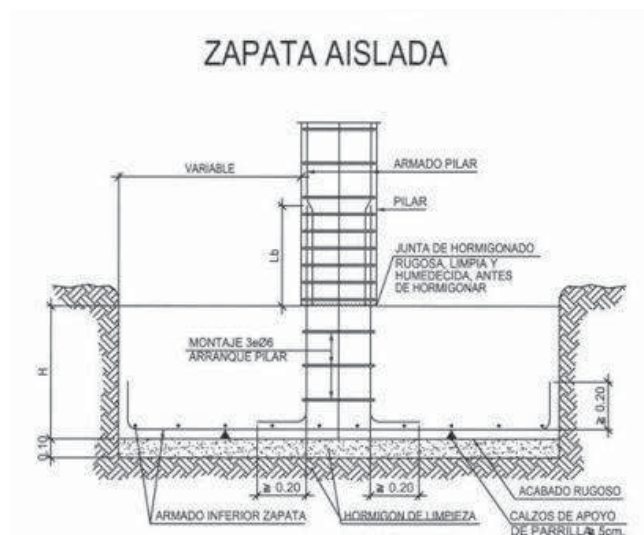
Detalle constructivo de una zapata aislada¹⁰³
